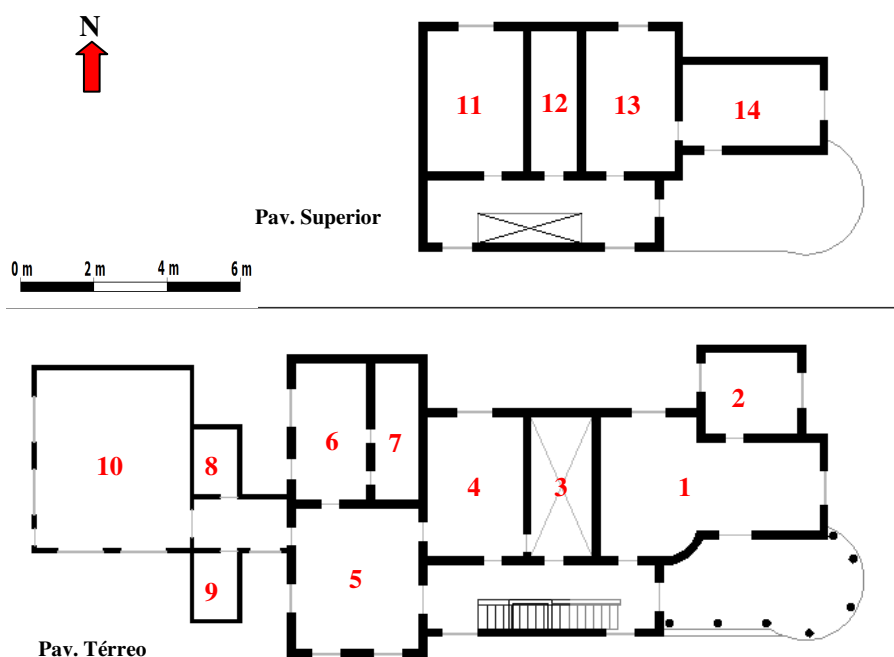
Planta dos pavimentos térreo e superior da edificação; e relação dos ambientes.
